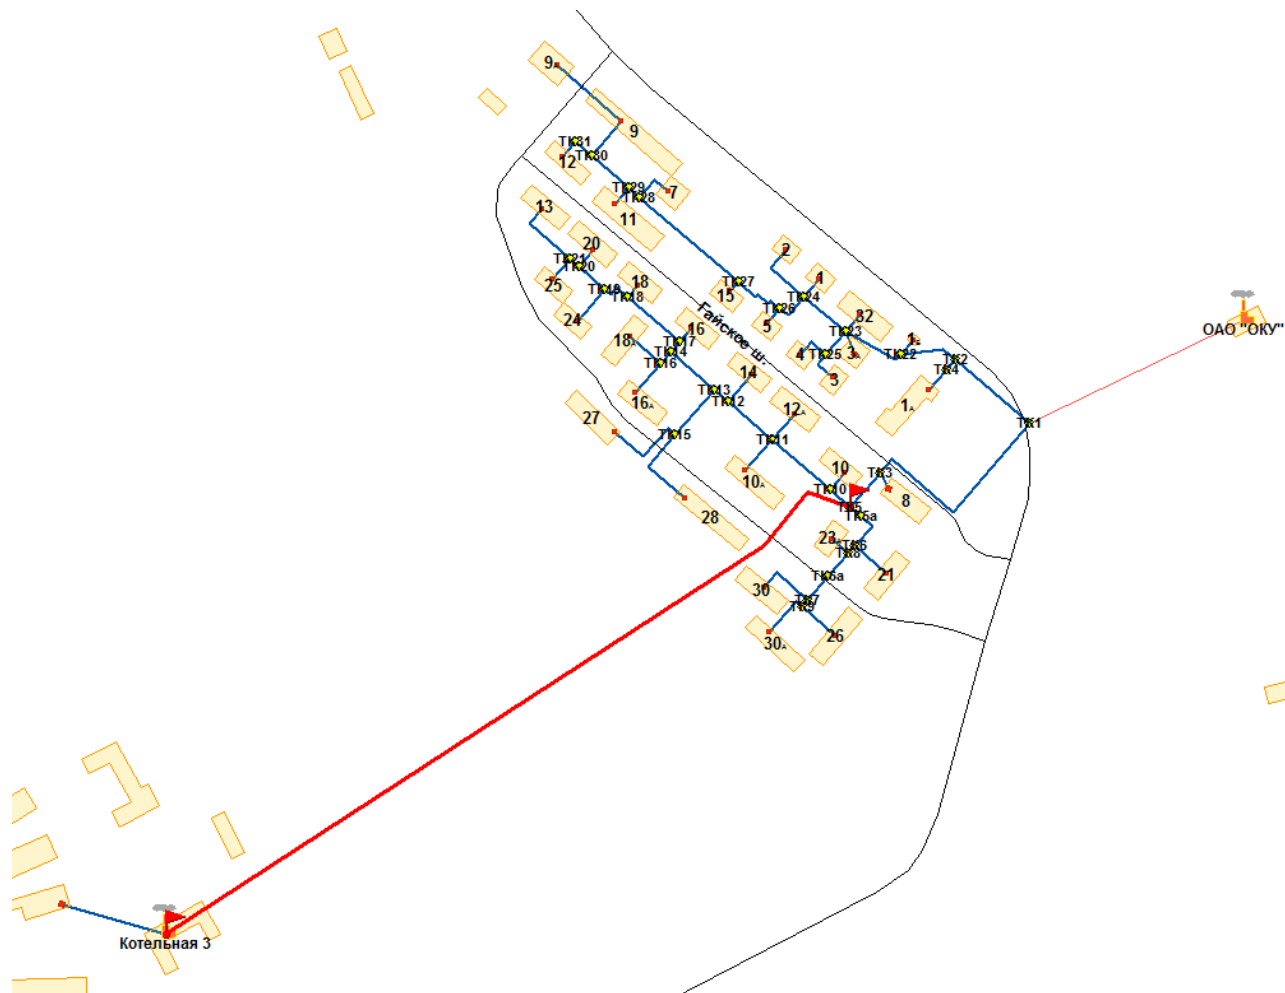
Схема прокладки трубопровода для подключения тепловой нагрузки котельной ОАО «ОКУ» к котельной № 3
